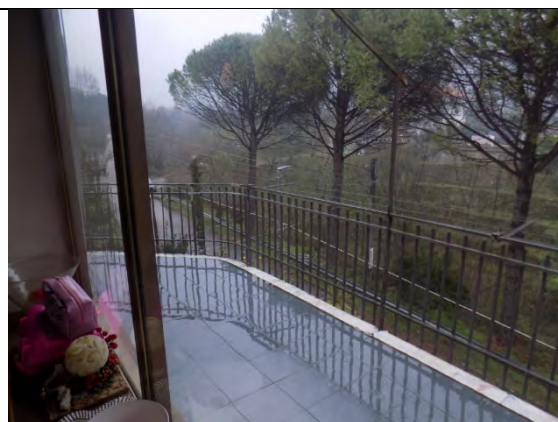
viste del vano verandato, Edificio di ubicazione Appartamento sub. 4, ultimo piano, laddove sul balcone prospiciente la cucina è stato ricavato un vano verandato. In basso viste dei succioli del tetto di copertura dello stabile part. 754, con evidenti fenomeni di distaccamento intonaco e di umidità.
